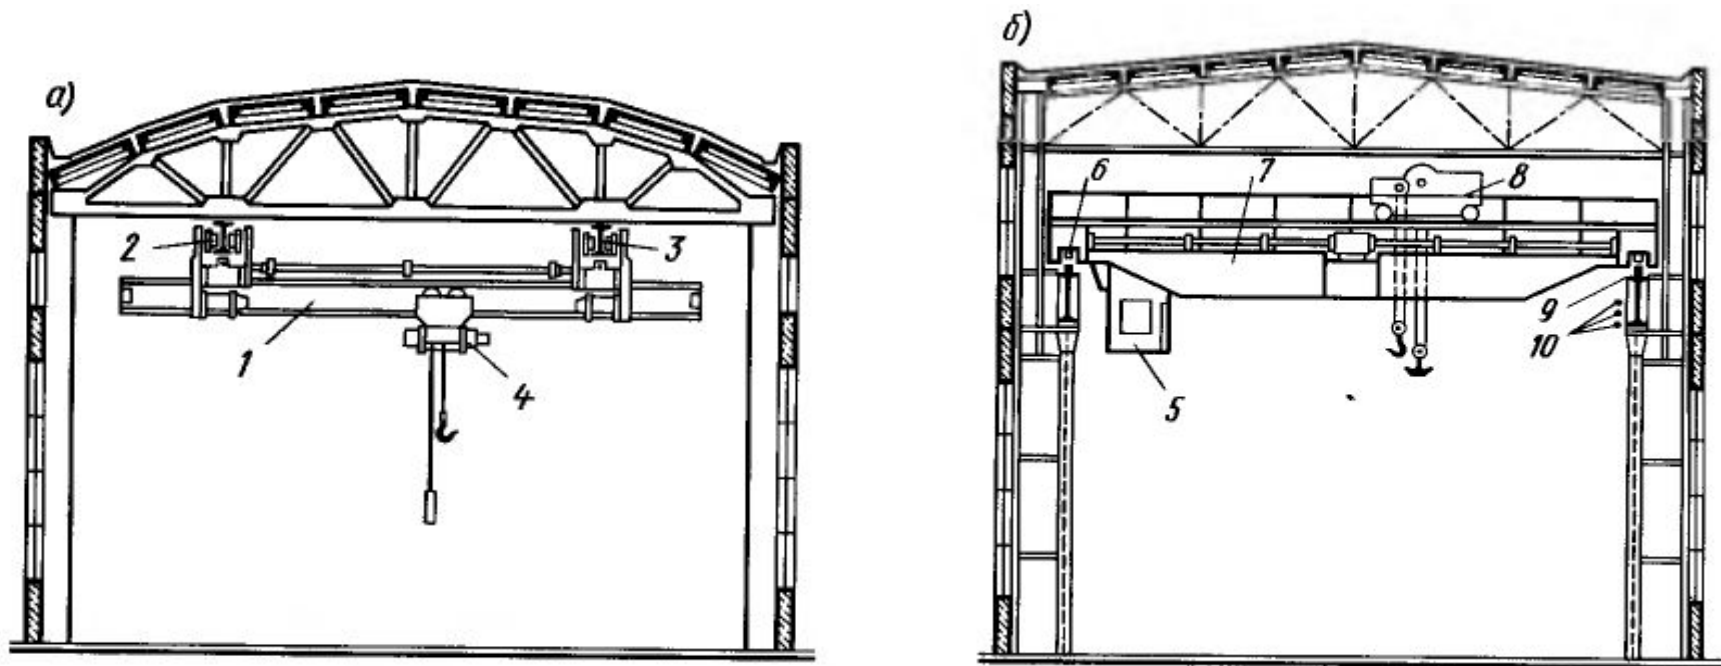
Схемы разрезов зданий с кранами: а – с подвесным краном, б – с мостовым краном. 1 – несущая балка, 2 – механизм передвижения, 3 – подвесной путь, 4 – электроталь, 5 – кабина крановщика, 6 – механизм передвижения вдоль кранового пути, 7 – несущий мост, 8 – тележка с грузоподъемным механизмом, 9 – подкрановый путь, 10 - токопровод
